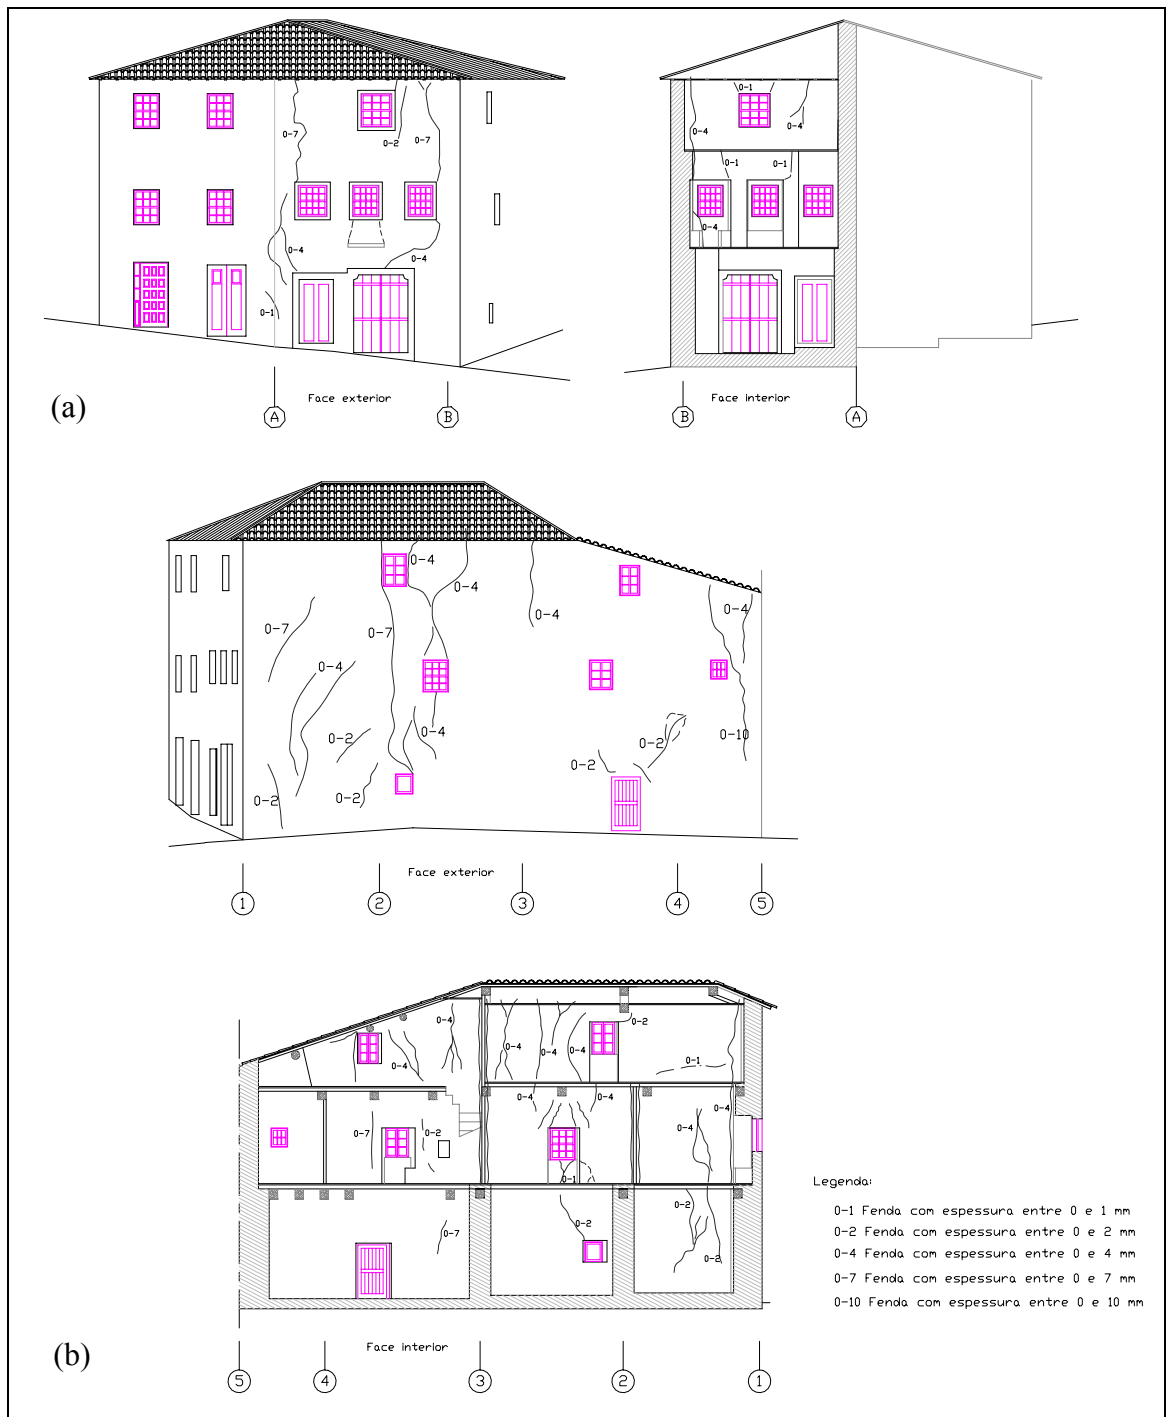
Mapeamento da fendilhação, interior e exterior, nas paredes mestras: (a) parede de fachada; (b) parede de empena.
